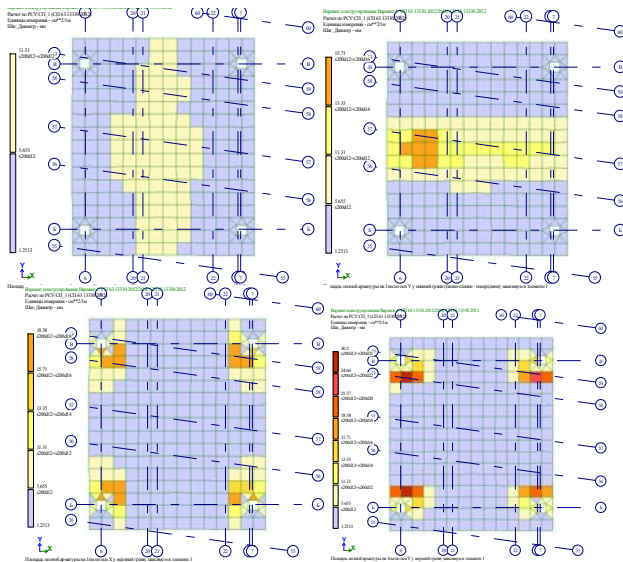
Схемы армирования покрытия автостоянки от второго варианта нагрузки (фрагмент)
